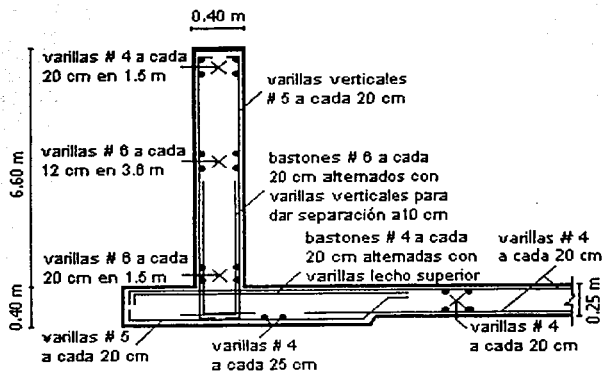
Acero de refuerzo en losa de cimentación y en muro
